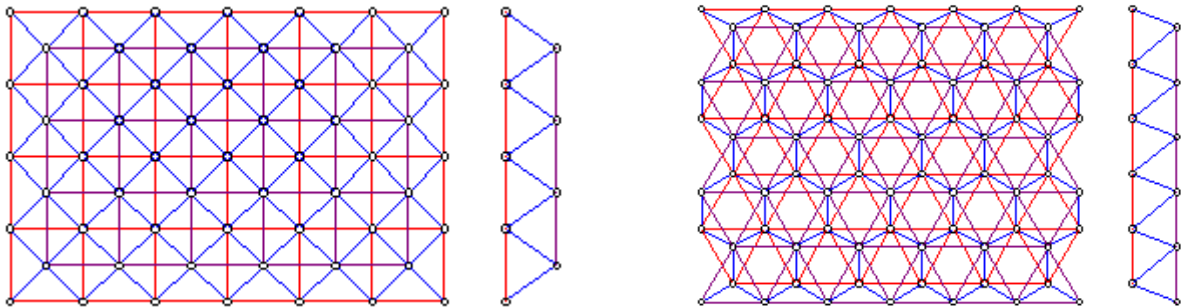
Exemple de structure tridimensionnelle composée de grille de poutres
